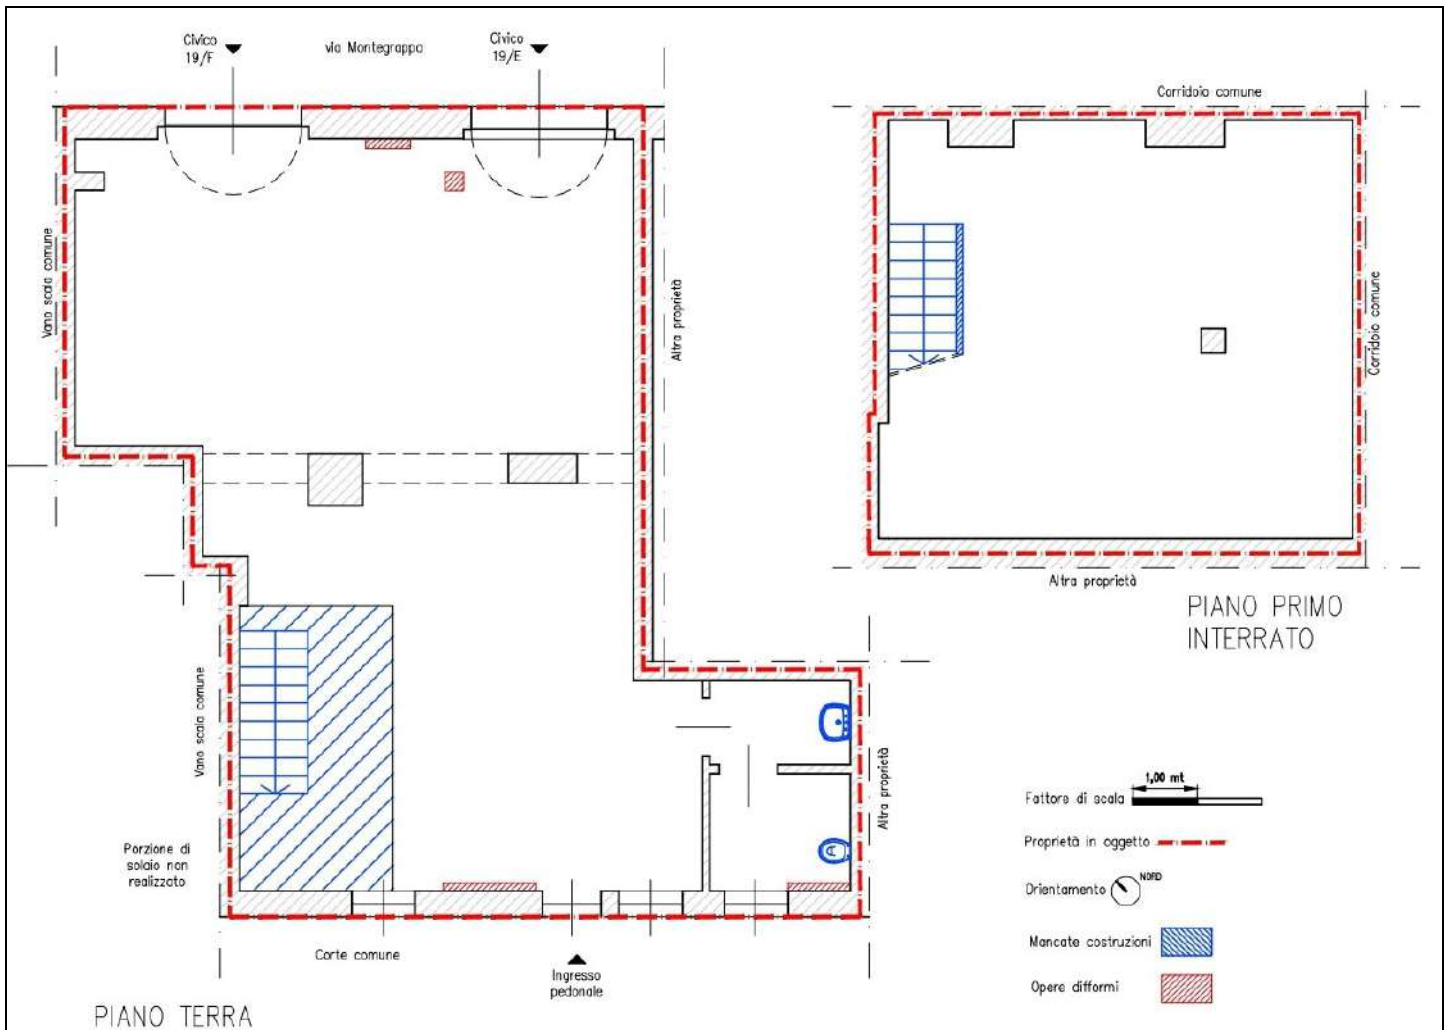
Pianta di confronto dell'immobile con ultima pratica edilizia approvata - D.I.A. del 14/12/2006 Prot. 54093
